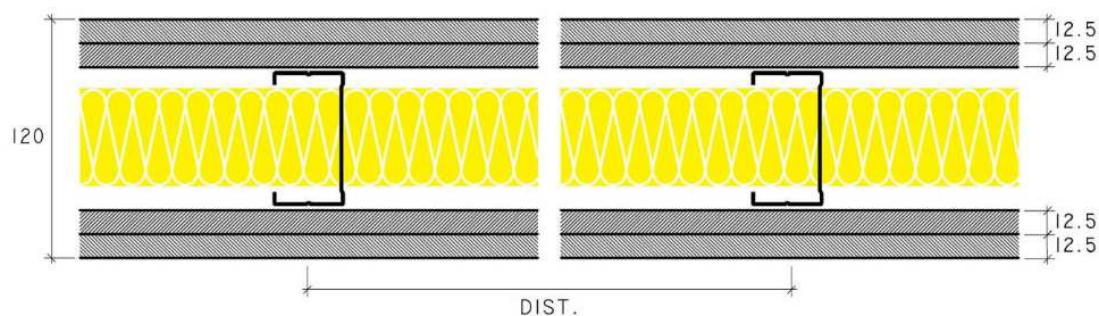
corte esquemático da parede autoportante em gesso laminado. [ (Gypteciberica, 2018)]
